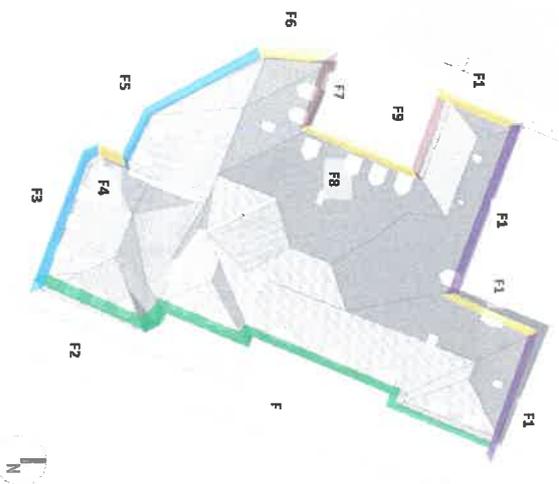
Plan masse du site - repérage des différents pans de façade : en vert façade Est ; en bleu façade Sud ; en rouge « façades intérieures » ; en jaune façade Ouest ; en violet façade Nord.
